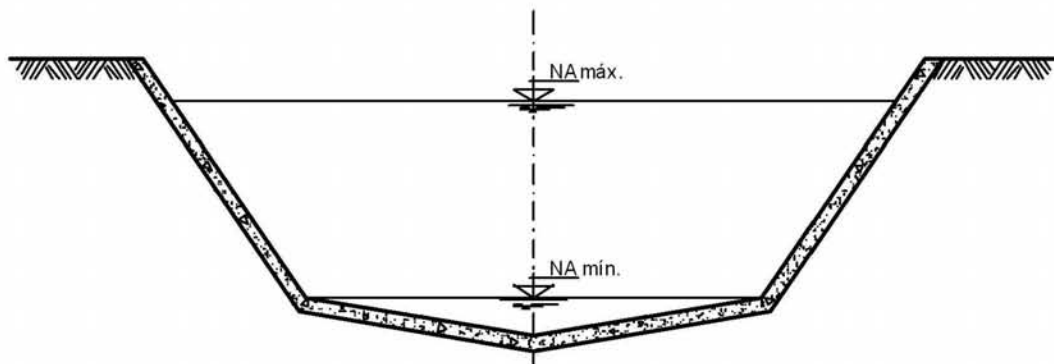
Canal en hormigón - Sección trapezoidal mixta
